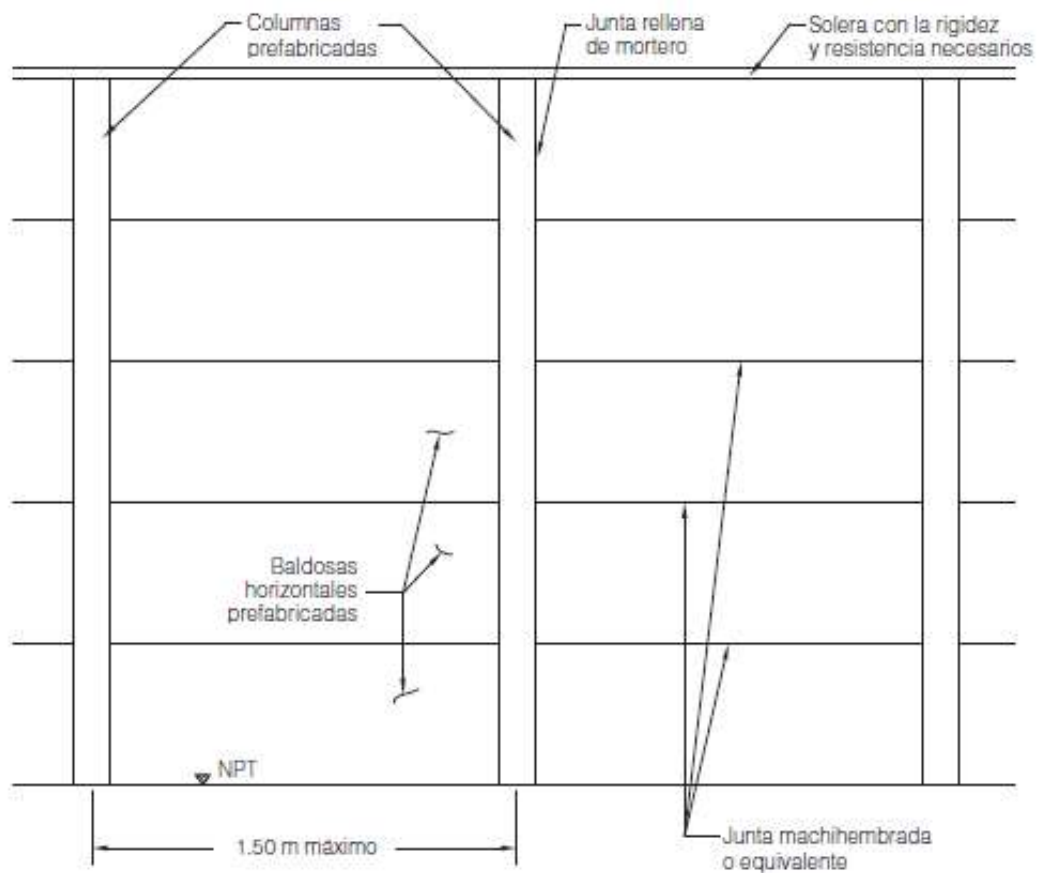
Sistema prefabricado de columnas y baldosas horizontales - CSCR, 2021.
